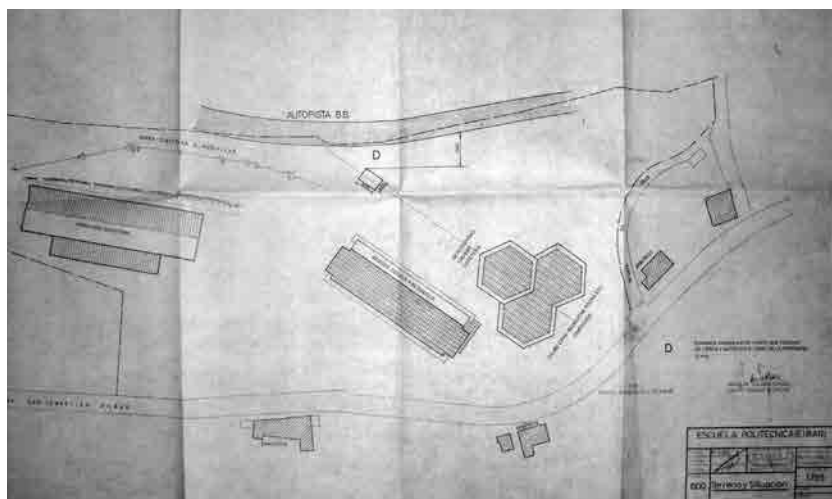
Plano de ordenación general de la primera fase del conjunto.
